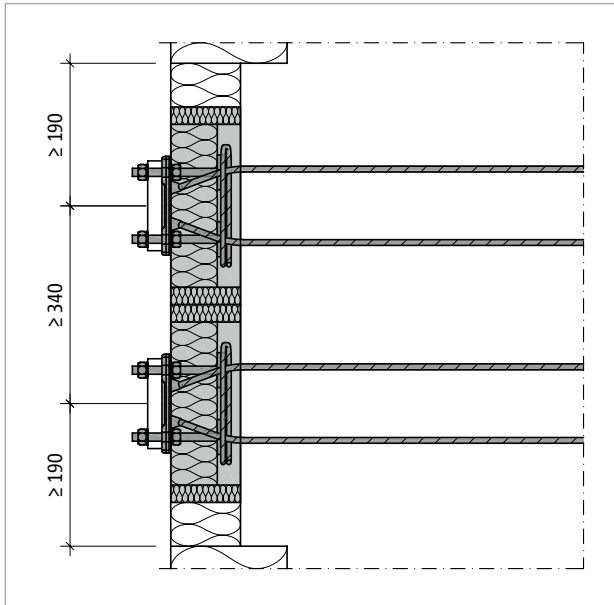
Schöck Isokorb® RT Typ SQ: Rand- und Achsabstände
